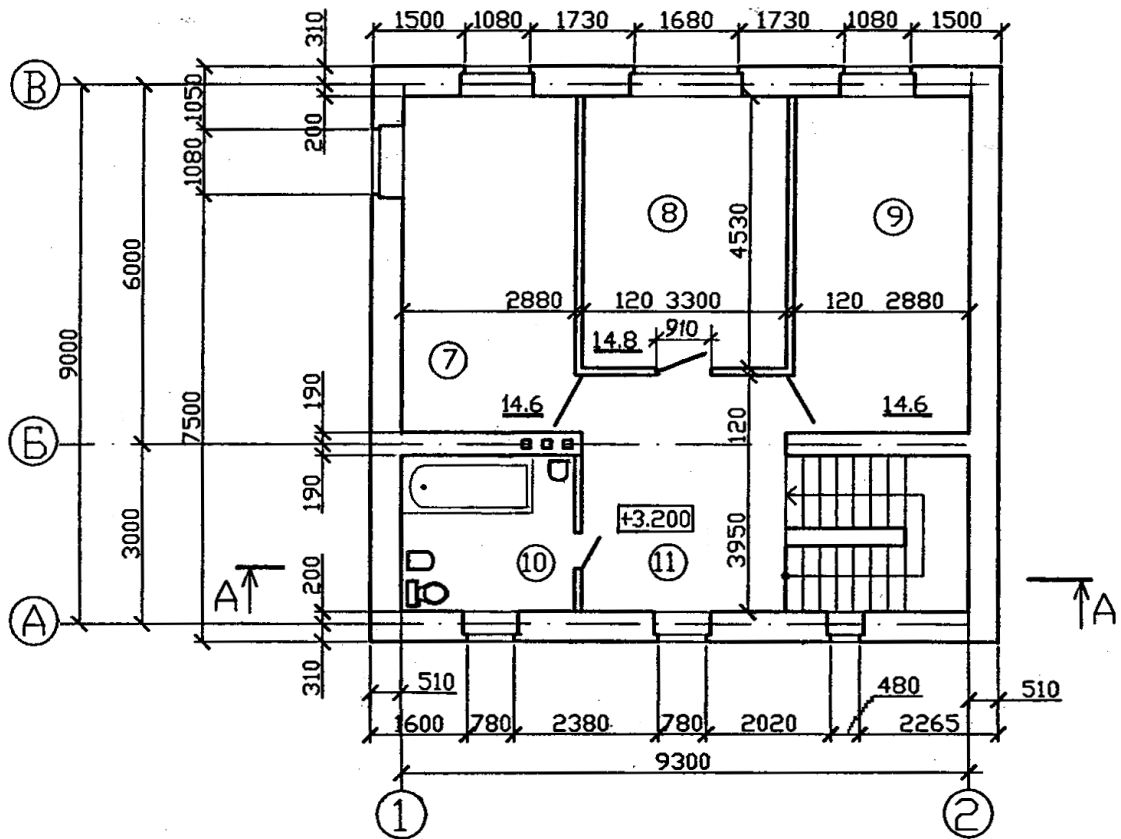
Пример выполнения плана 2-го этажа (M1:100)
